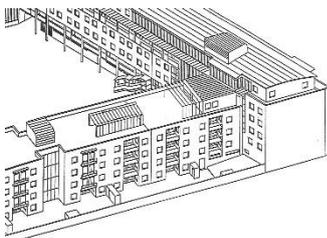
Bauteil Arch. Ullmann mit Dachterrasse und Pergolen
